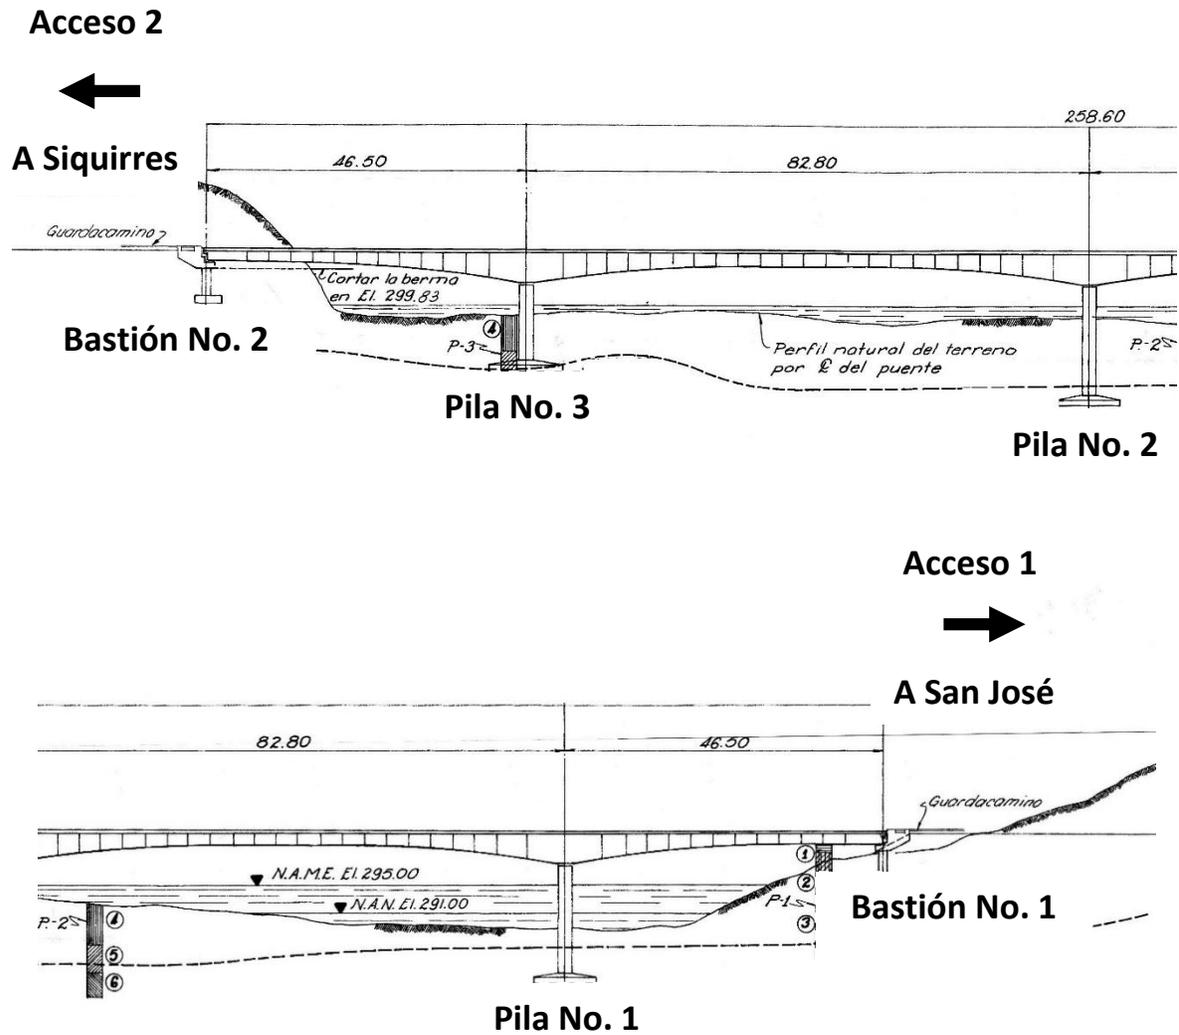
Figura D. Identificación en planta utilizada para el puente sobre el río Toro Amarillo.
